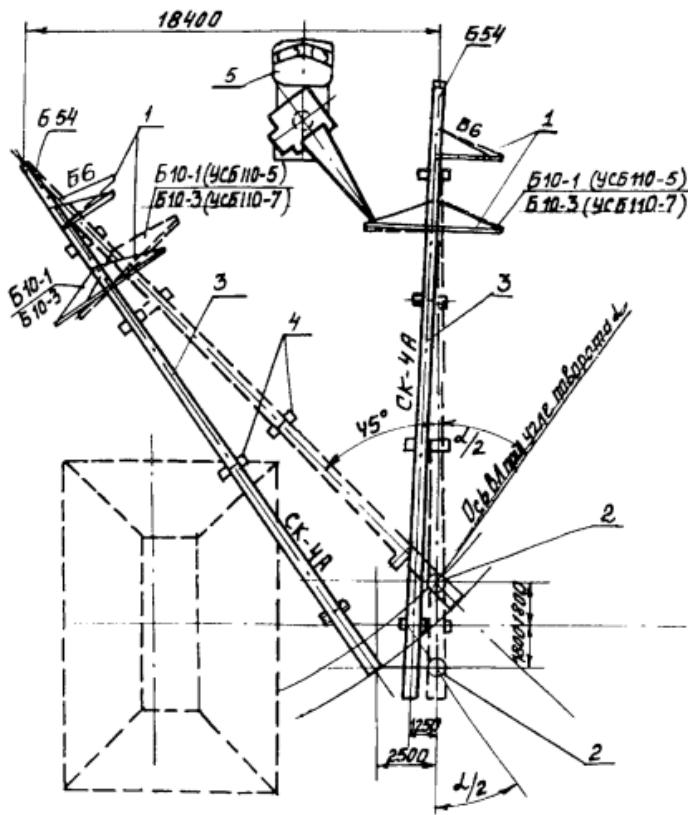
Схема выкладки и сборки опор: УСБ 110-5; УСБ 110-7
